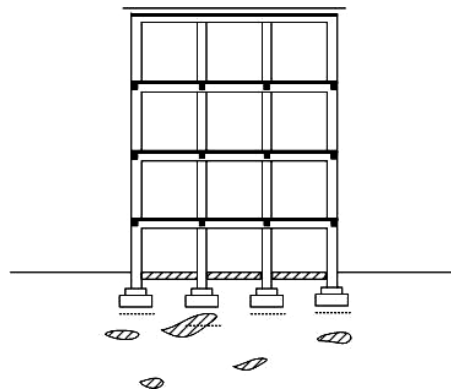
Structură de beton armat în cadre, cu fundații izolate sub stâlpi
